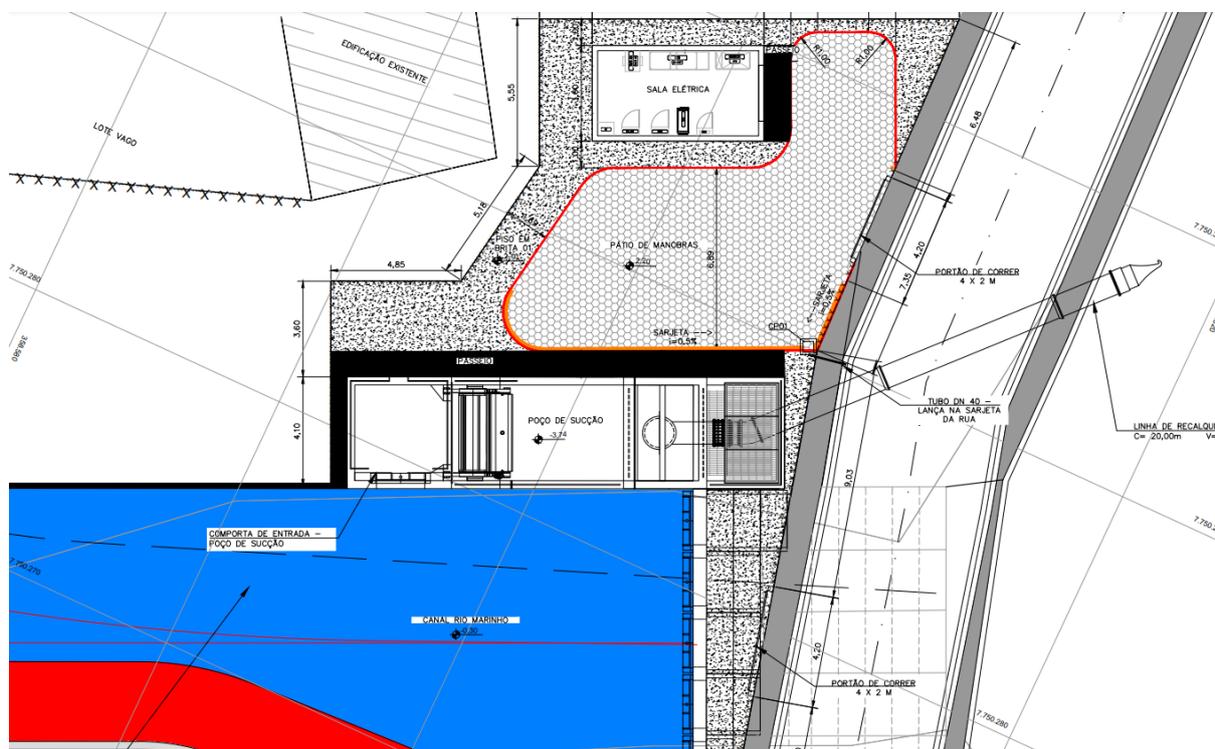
Planta do Poço de bombas da rua Iraci Cortelete
